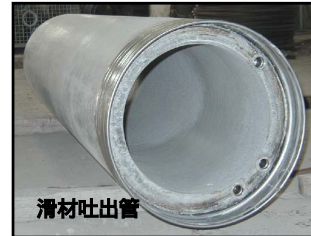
スーパーマイクロ工法用管(トリプル吐出管)
